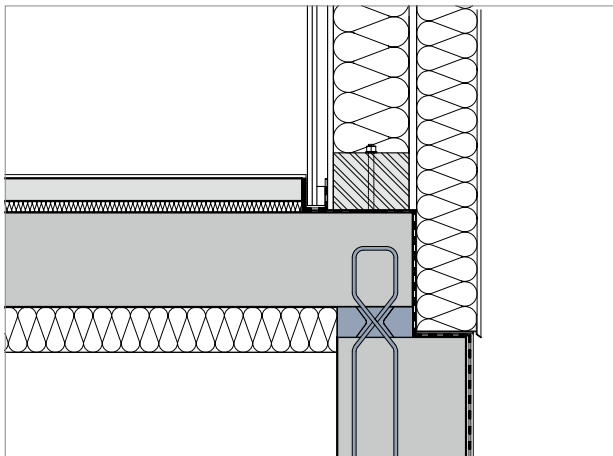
Außenwand mit Schöck Sconnex® Typ W über einer Tiefgarage
